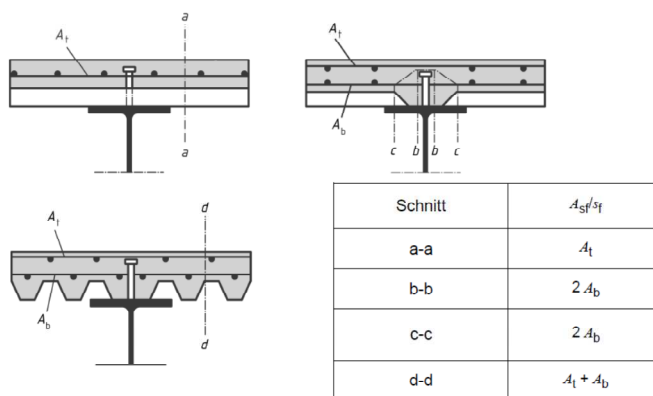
Maßgebende Schnitte für den Nachweis der Längsschubtragfähigkeit bei Betongurten mit Profilblechen
